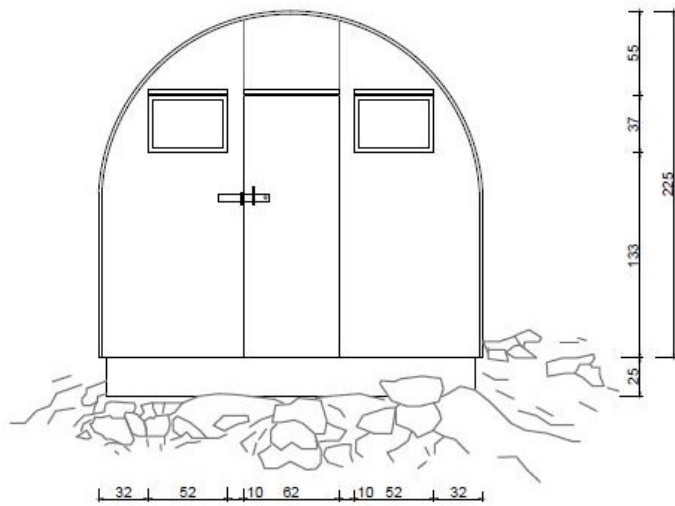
103 Bestandsaufnahme _Ansichten und Grundriss
